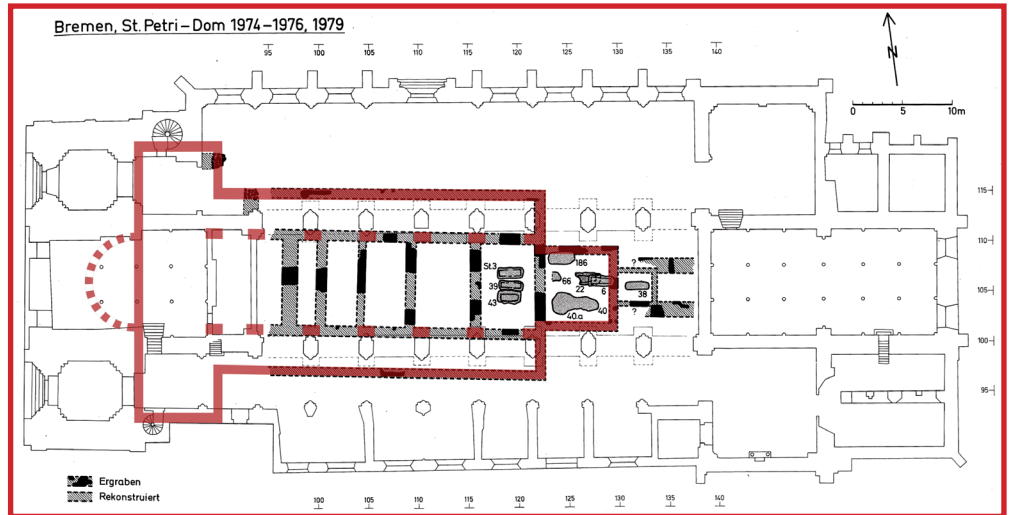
Bremen, Dom, Rekonstruktion Bau II von 860 Grundriss (Einzeichnungen Georg Skalecki)
